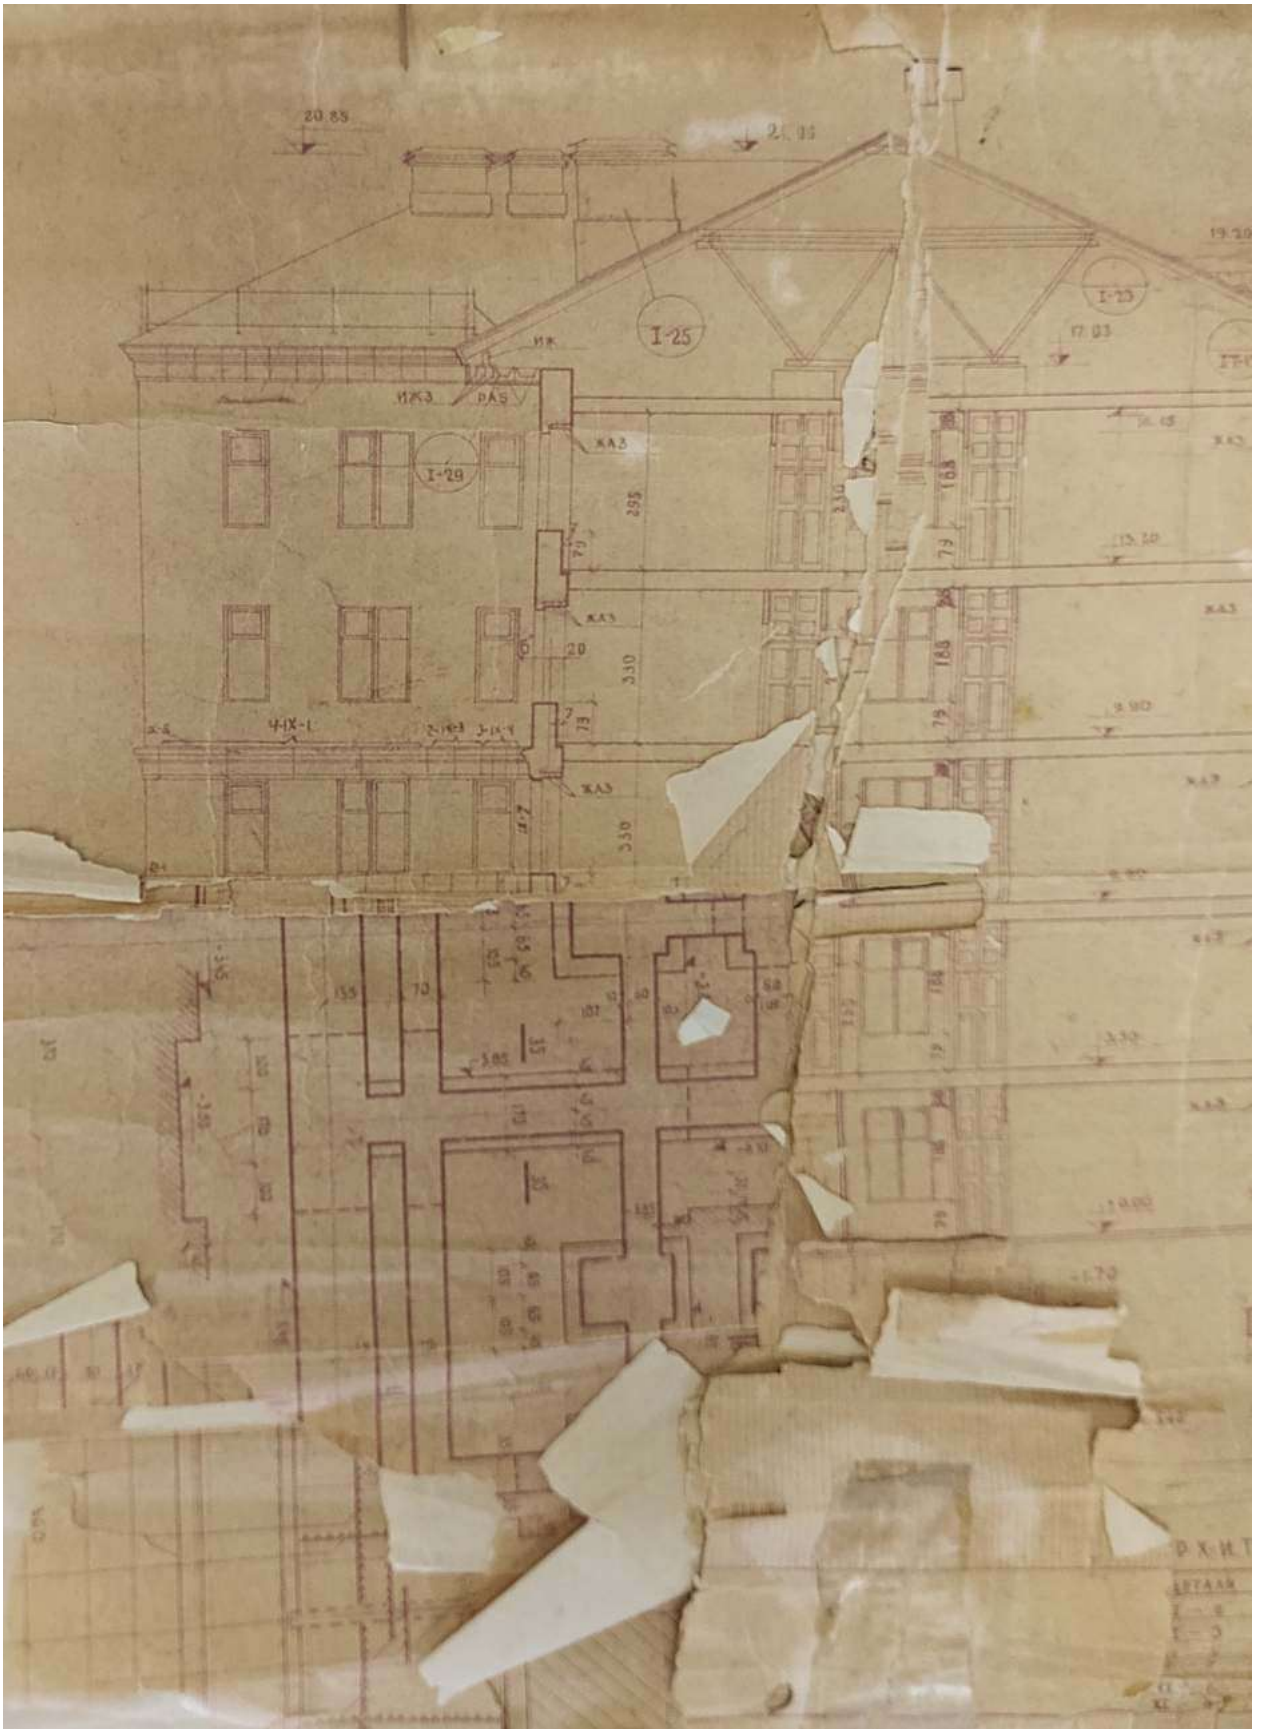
Фрагмент типового проекта № 1-409-2. Фрагмент дворового фасада и разрезы
